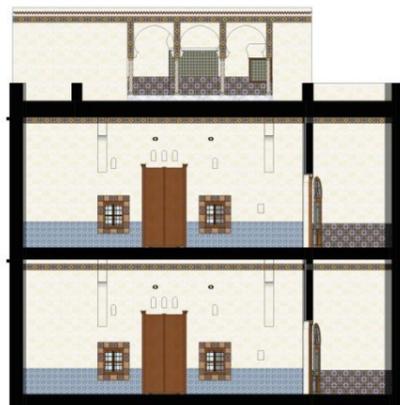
Coupe sur la façade intérieure OUEST. (Source Auteure).
